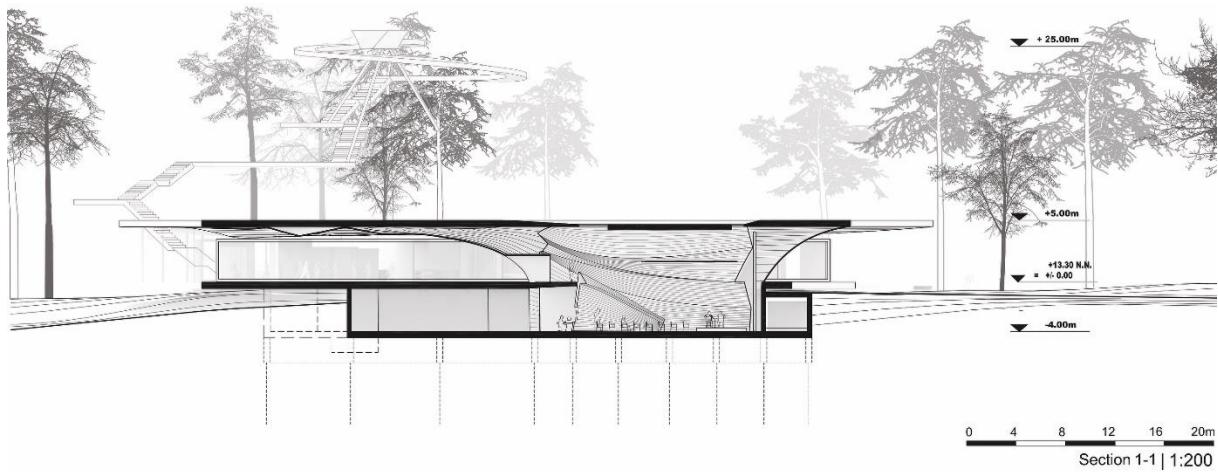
Extrait de la 4e planche rendu, coupe 11 et élévations
